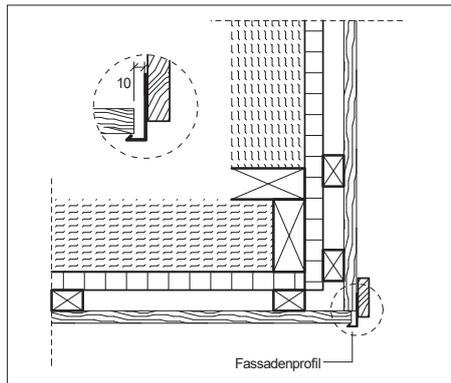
Fassadenecke bei Profilschalung mit Fassadenprofil (z. B. Blechformteil) und Abdeckbrett. Zwischen Fassadenprofil und den Brettenden ist eine Fuge von 10 mm angeordnet. Die Hirnholzflächen sind durch das Fassadenprofil abgedeckt.
